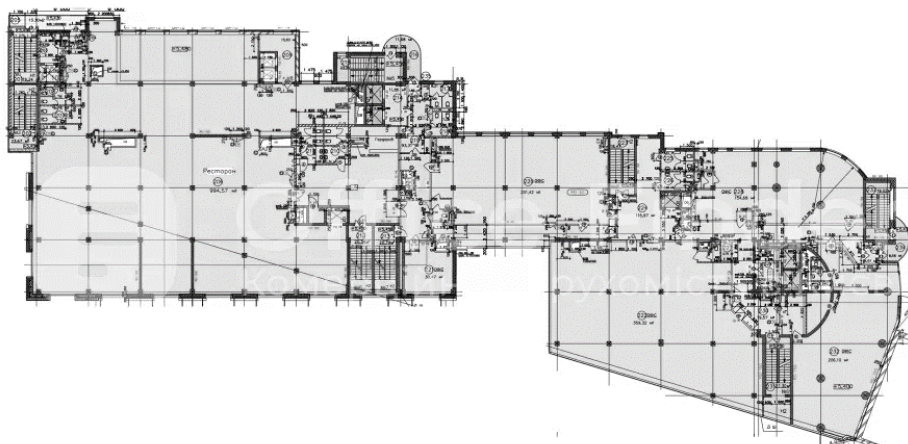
Планування типового поверху Бізнес-центру Лувр
